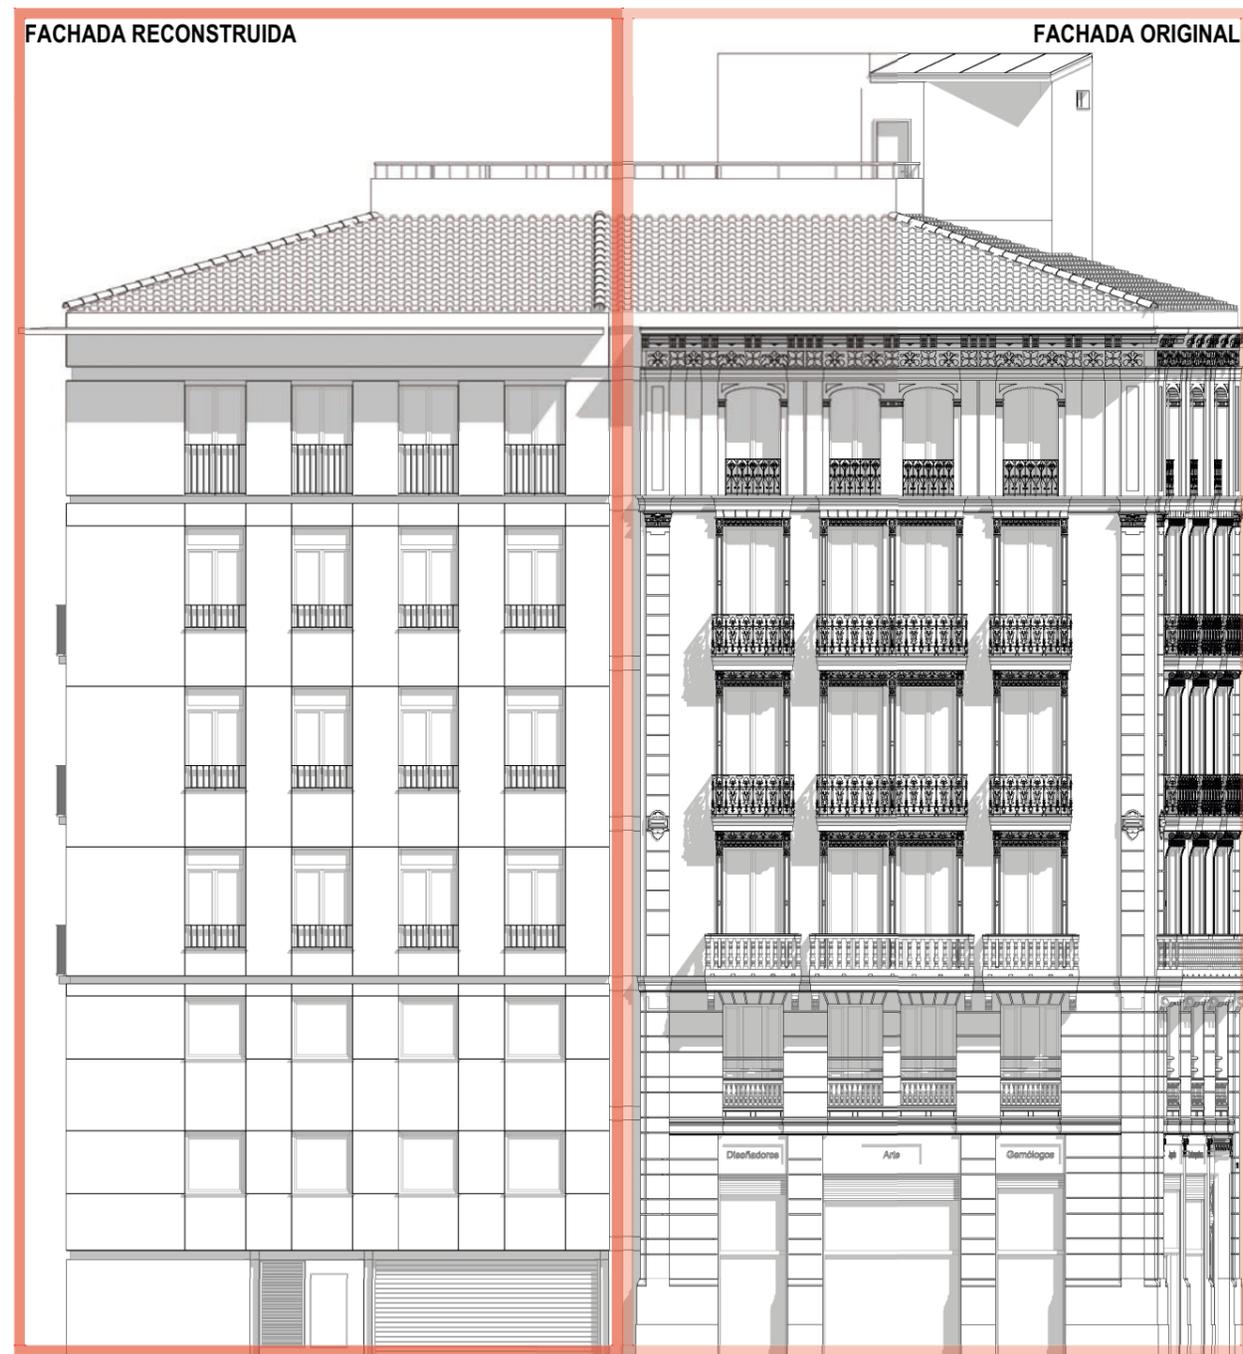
Alzado compositivo. Fachada original-Fachada reconstruida.
